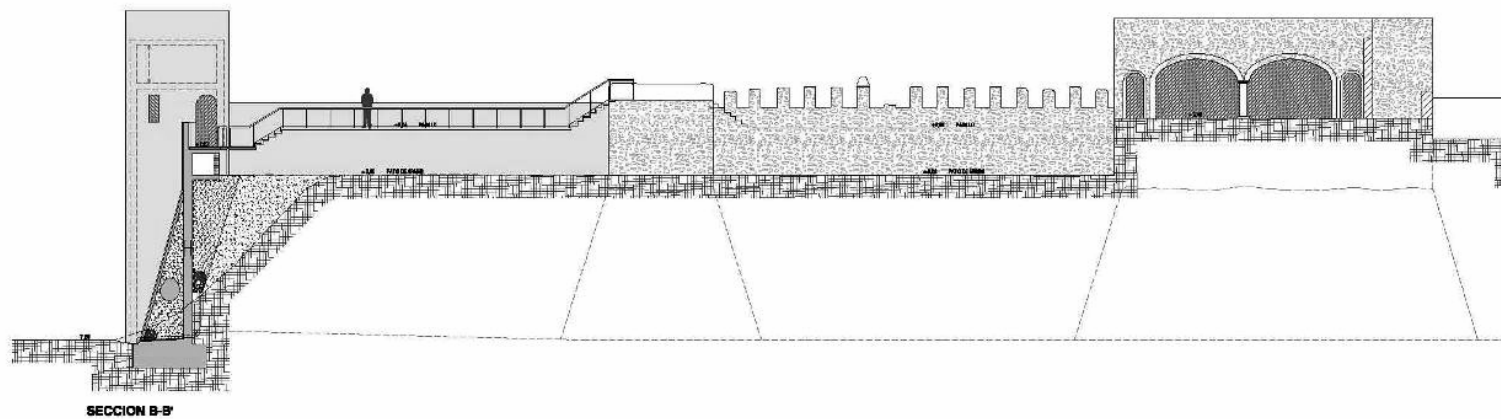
Sección transversal del talud entre las torres Oeste y Noroeste. Estado modificado.
